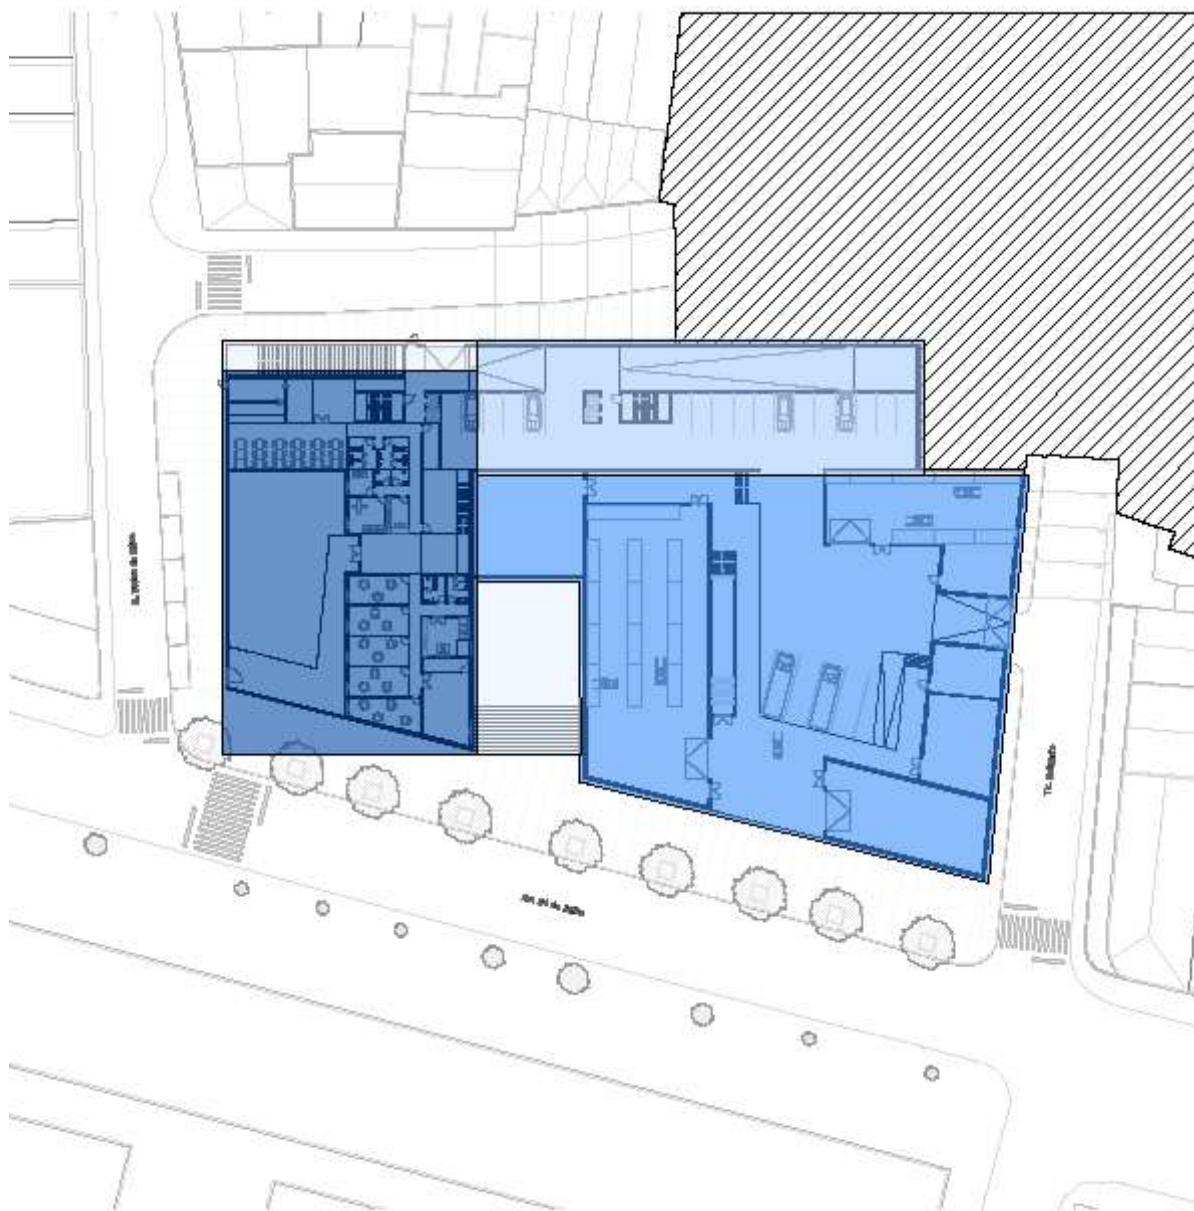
Planta do piso térreo com a organização programática, reduzido da escala 1:125 (Fonte: Autor)
